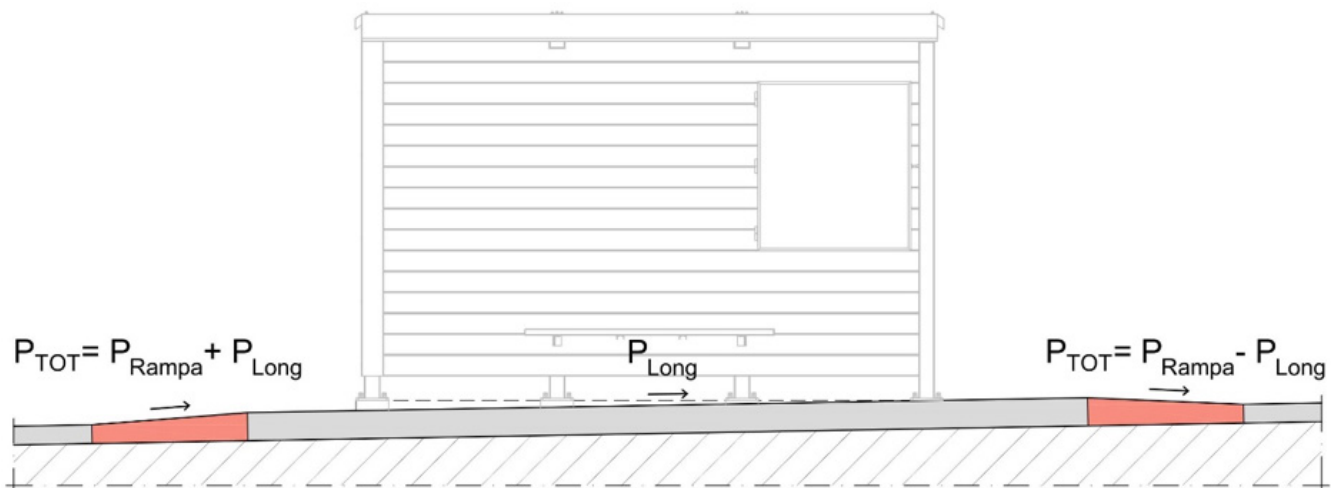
Zustiegsrampe Haltestelle und Längsneigung
